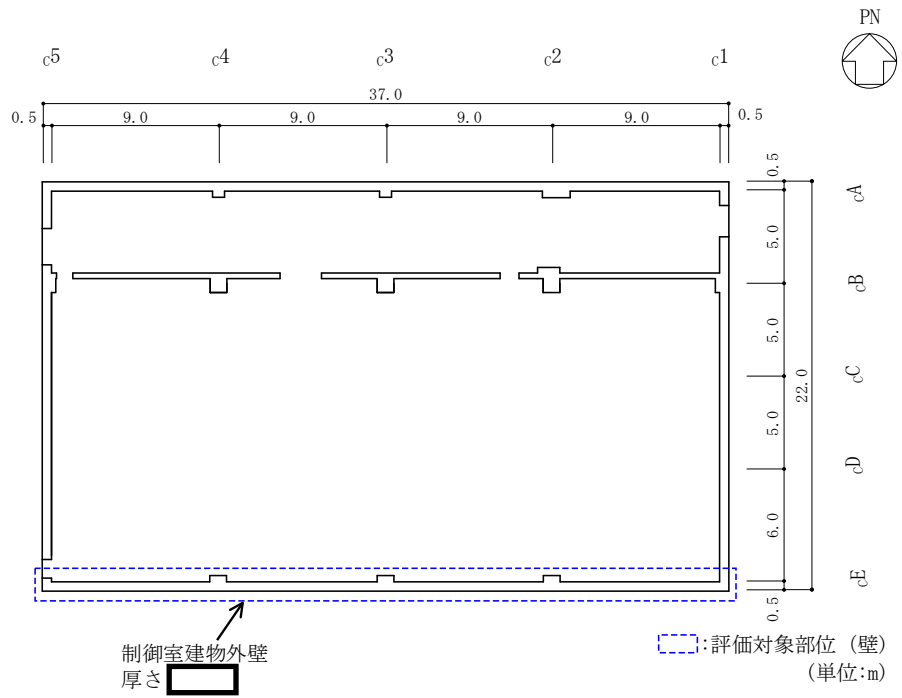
(1) 制御室建物の概略平面図 (EL 16.9m)
